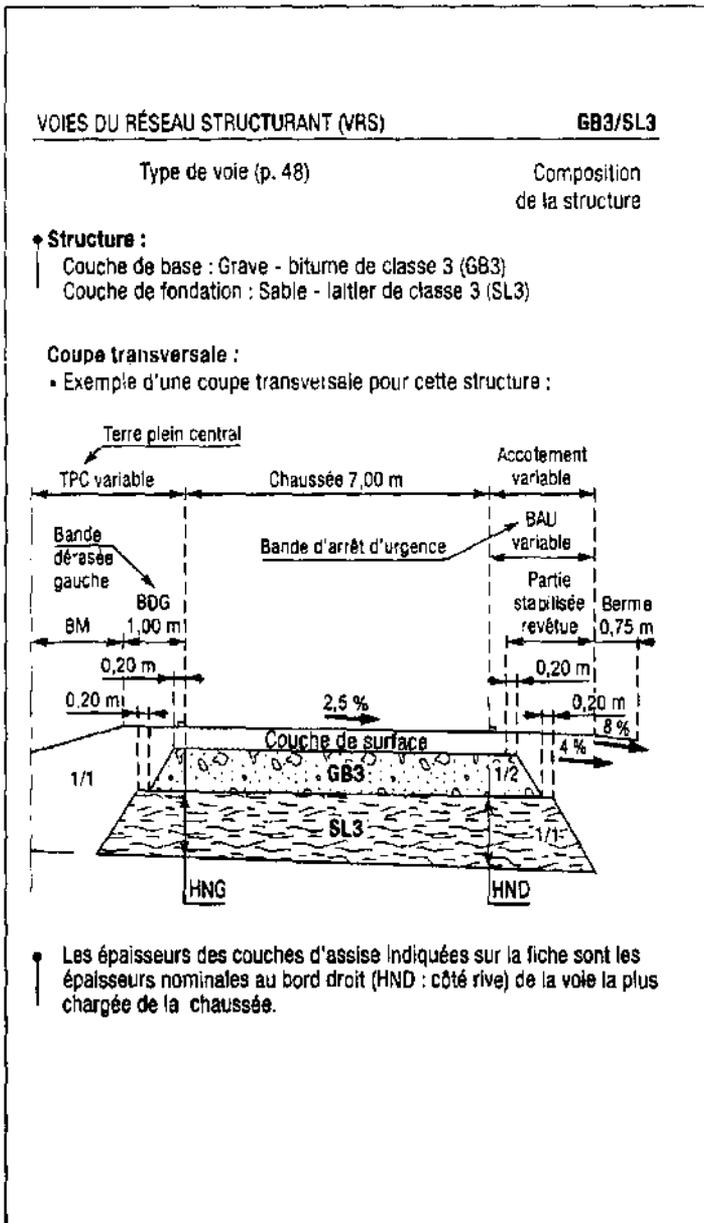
Extraits de la fiche de structure GB3-SL3.
